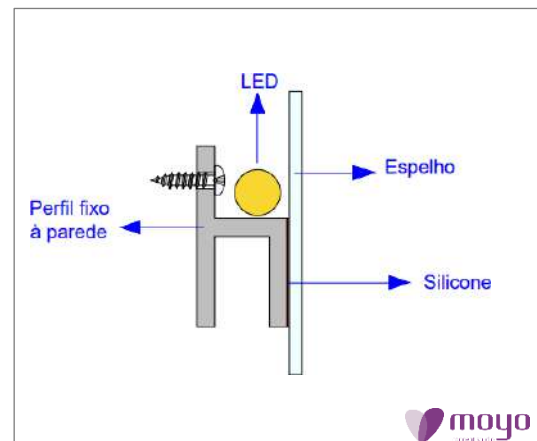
Desenho Técnico da estrutura de fixação Nº2
